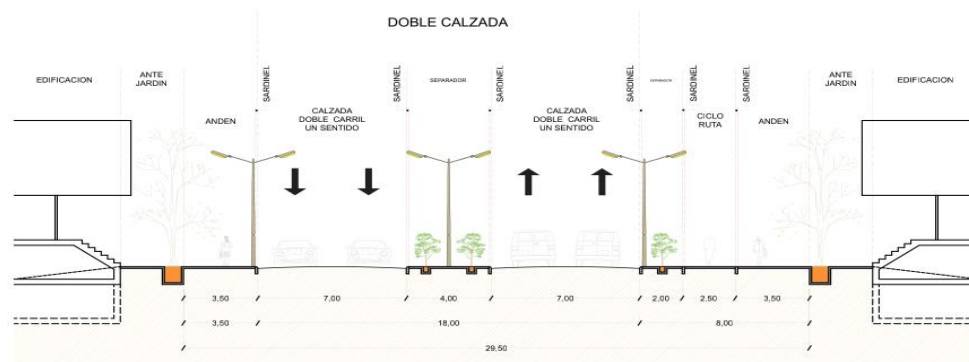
Perfil Vial Carrera 11 VILLA OLIMPICA
